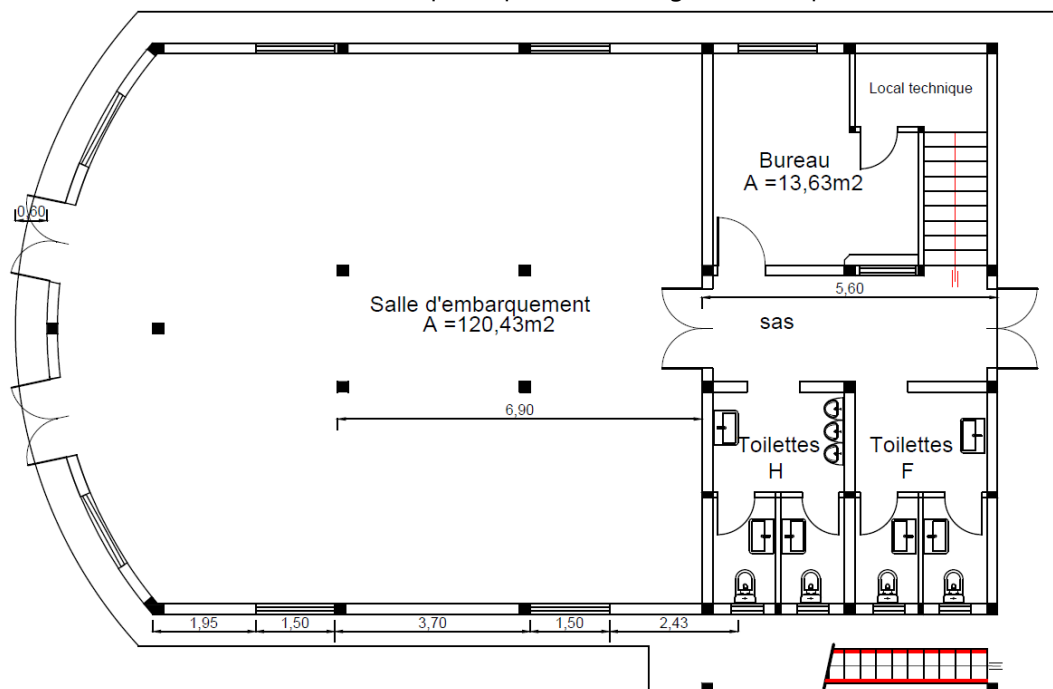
Plan masse du nouveau bâtiment portuaire principal - RDC
